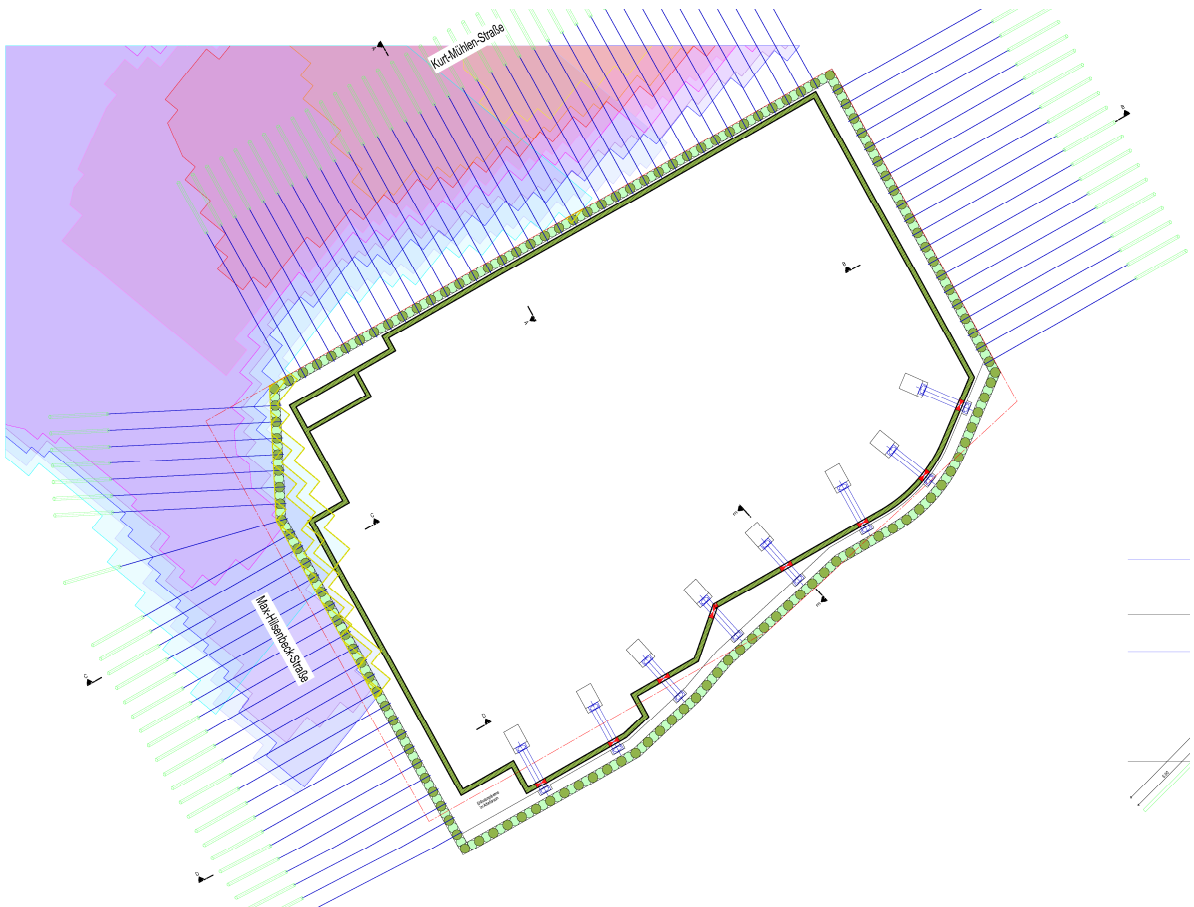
Baugrubenverbau mittels überschrittener Bohrpfehlwand (Grundriss)
